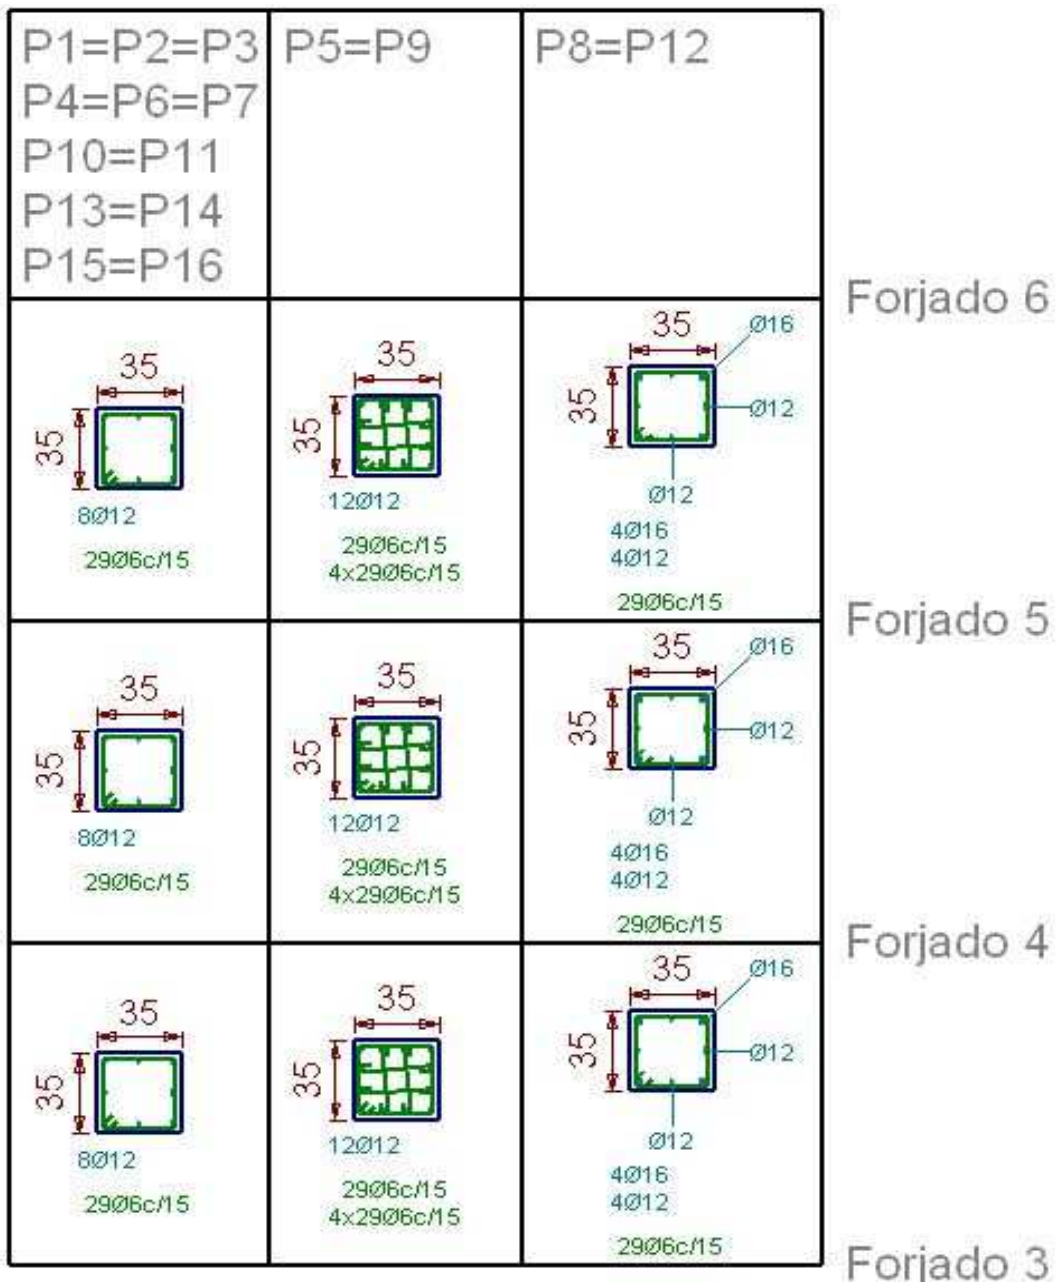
Armadura en pilares (1). Edificio de 6 plantas (G).
